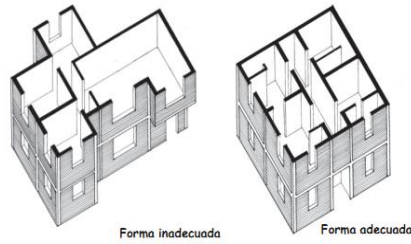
Configuración estructural de una vivienda (Blondet, 2005).
